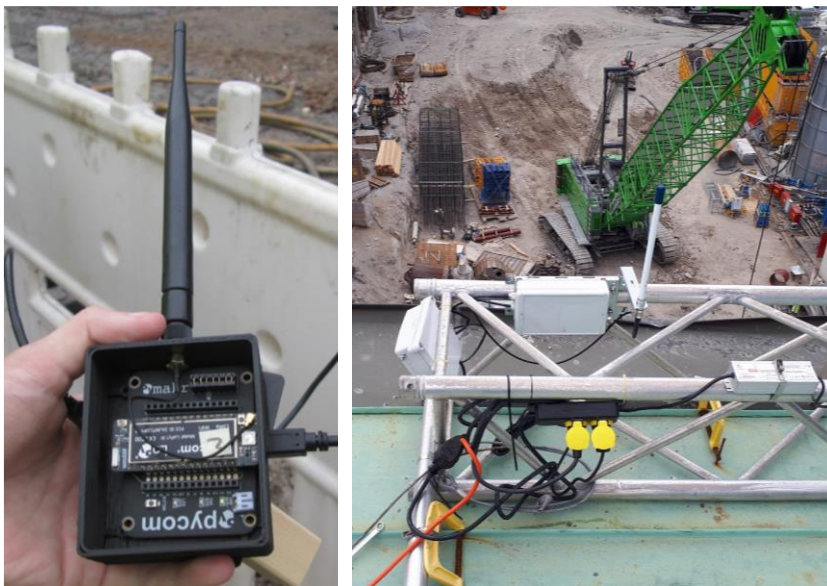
Mobile Bridge (links) und Gateway Baustelle (rechts)⁶⁵⁰
